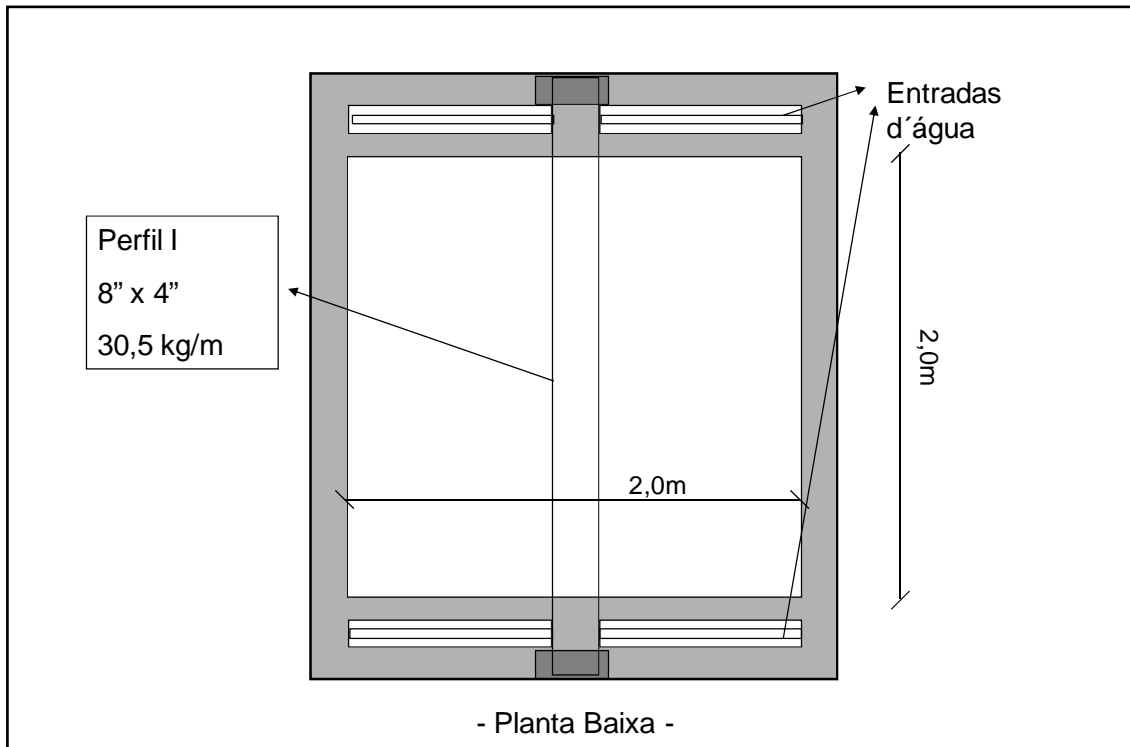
Projeto do tanque-teste mostrando as paredes duplas com entradas d'água e a viga metálica tipo I para suportar o sistema de aplicação de carga.
